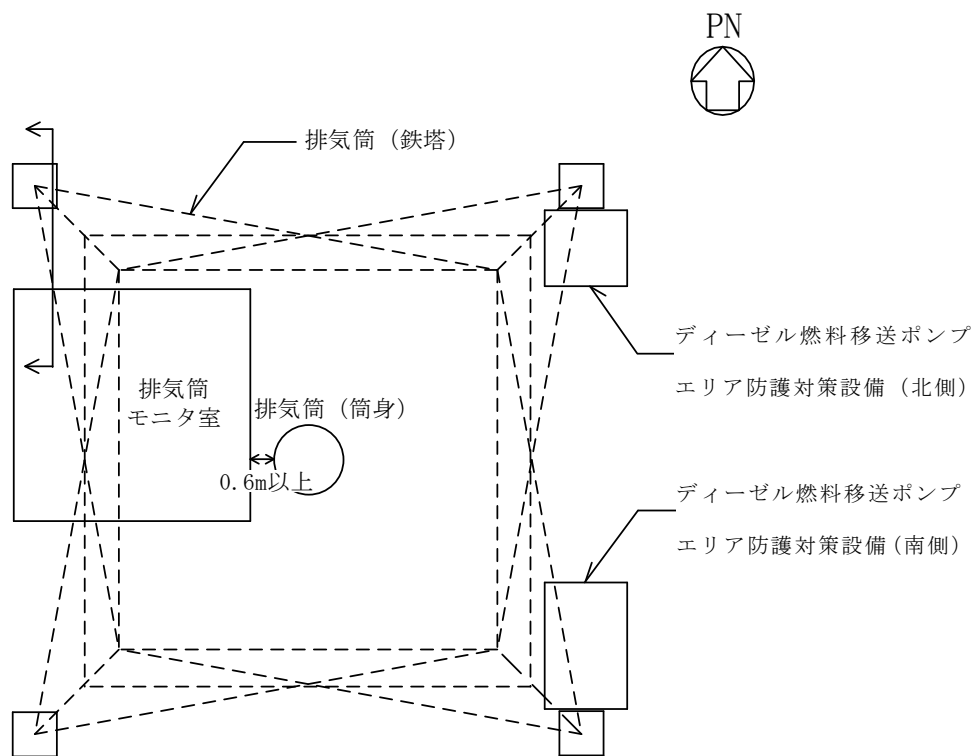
(2) 建物配置図 (排気筒モニタ室及び排気筒の詳細)
